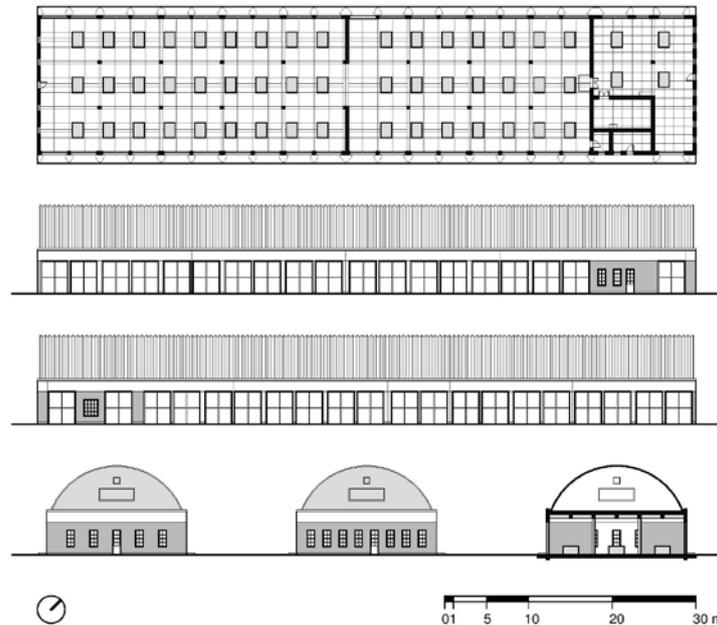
Rehabilitación del pabellón de artillería norte: planta principal, alzado sureste, alzado noroeste, alzado suroeste, alzado noreste y sección transversal de la construcción (Drawing by Pablo Llamazares Blanco).
